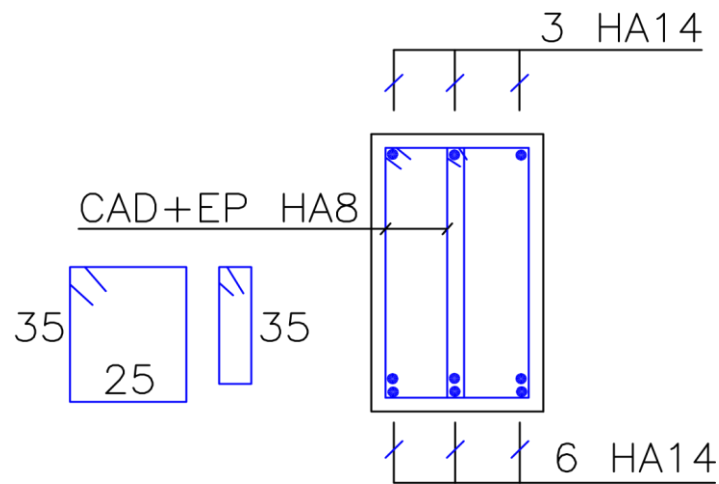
Ferrailage des poutres secondaires au niveaux 1^{er} étage à 8^{ème} étage
